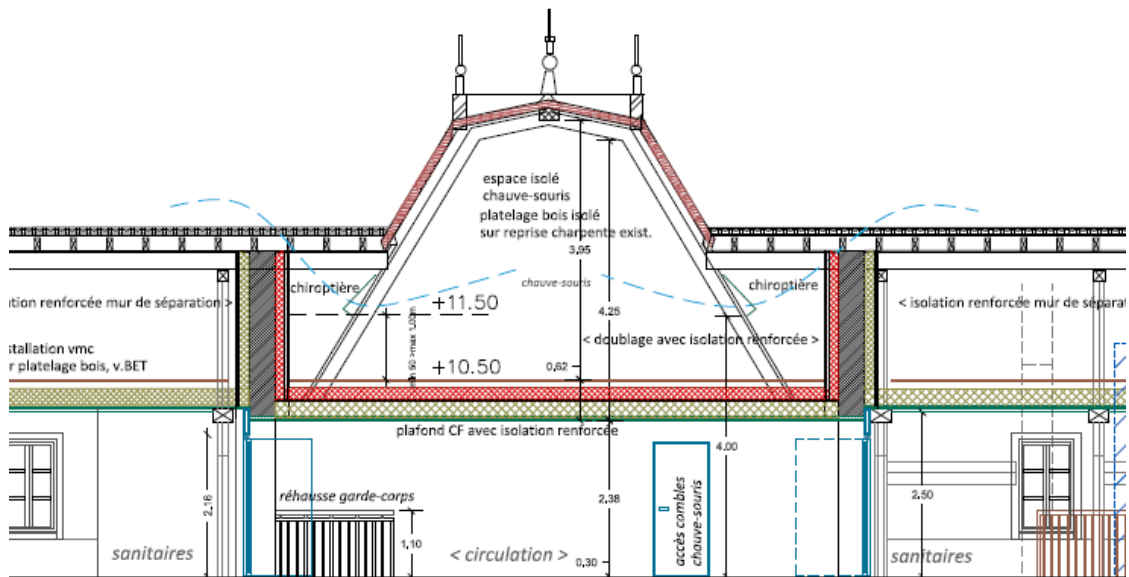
Plan de coupe de l'espace dédié aux chiroptères
